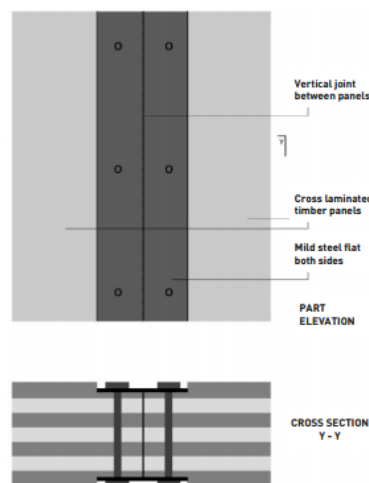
Ligação entre painéis CLT através de placas planas de aço (Chapman, 2010).
